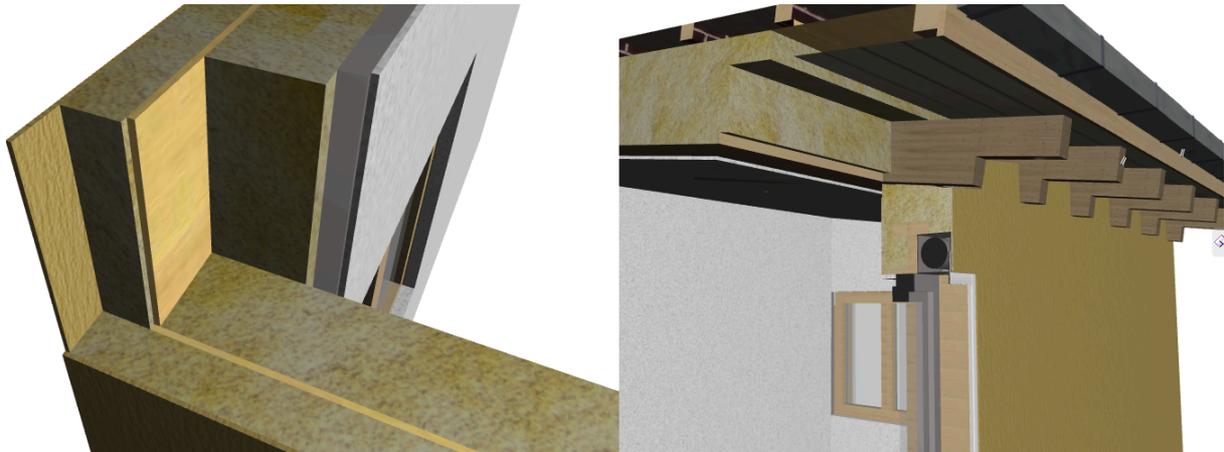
Visualisation tridimensionnelle des jonctions d'éléments (plan horizontal et plan vertical)
